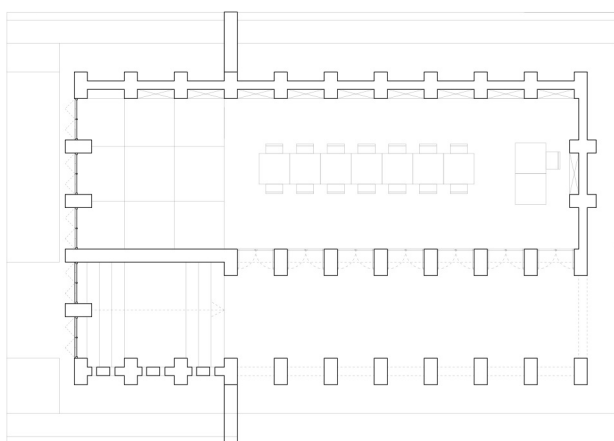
Pianta della libreria di Muyinga ©BCarchitects
